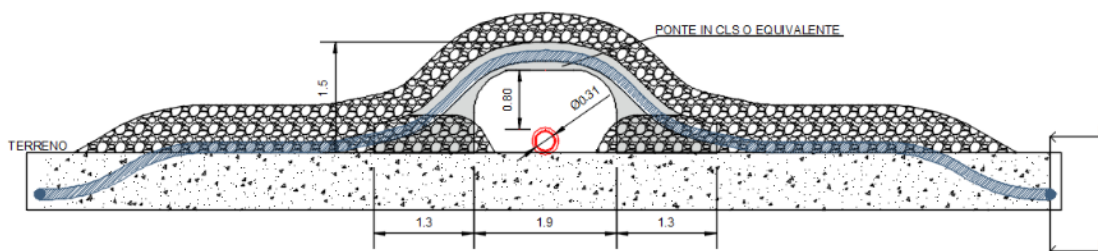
Scavalco di una condotta affiorante con Concrete Bridge ricoperto di pietrame
